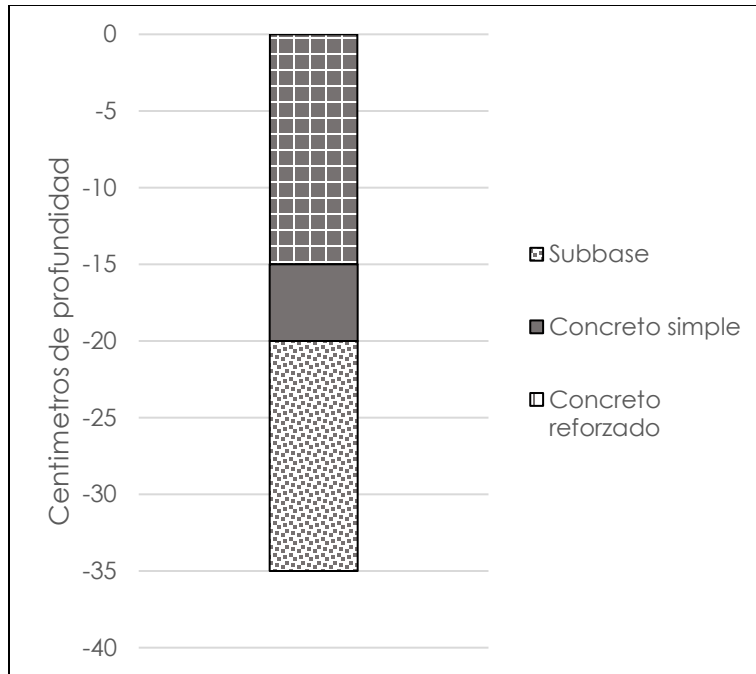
Corte de la estructura de pavimento para el proyecto de Málaga-Santander
